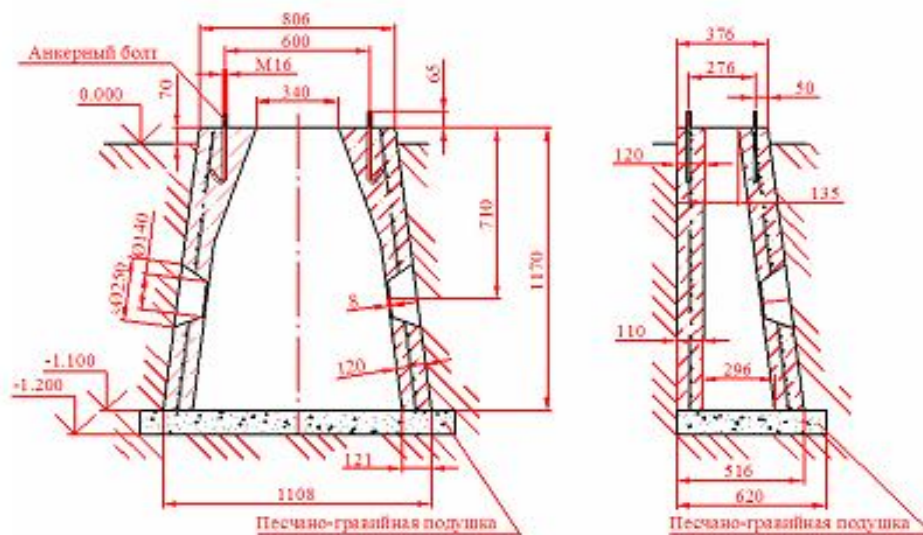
Бетонное основание (фундамент) под шкаф ШРО-600
